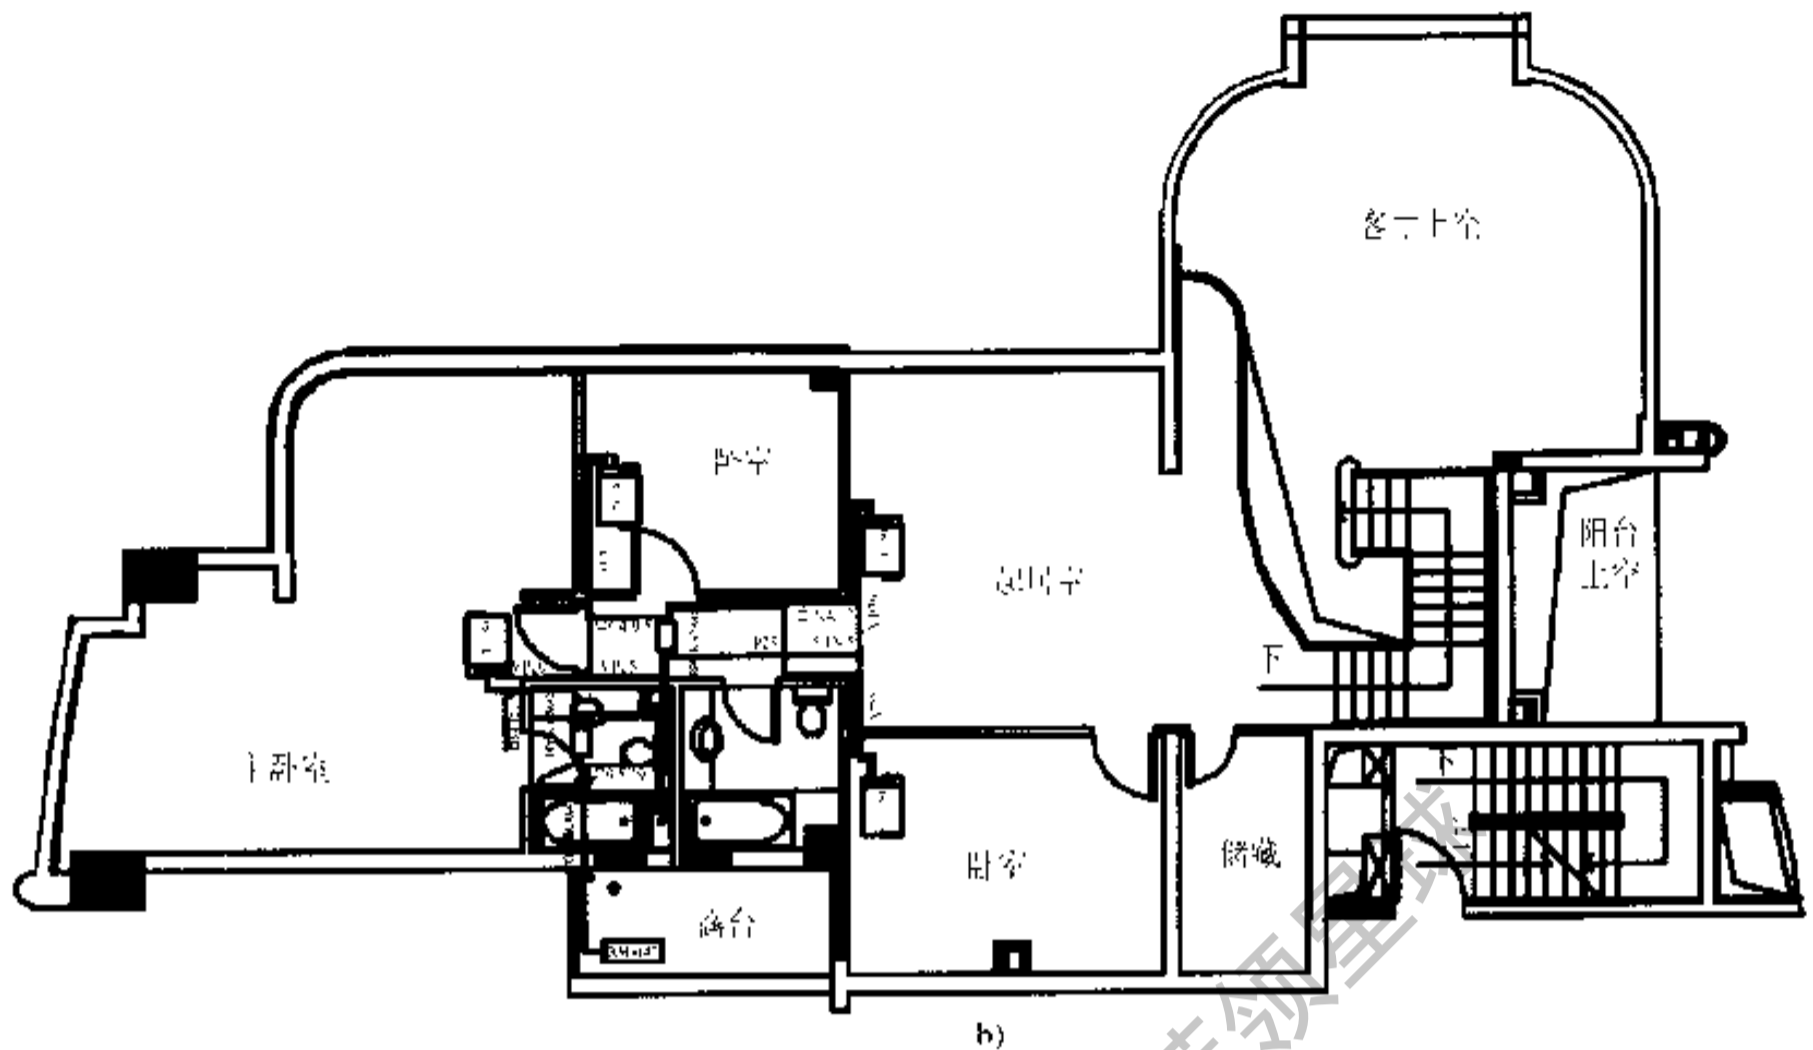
杭州绿园 B5 户型空调平面图 (续)
